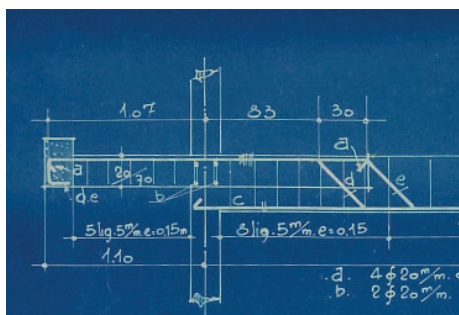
Plano del forjado de techo de planta baja de la Villa Cook a escalas 1:50, 1:20 y 1:10, Summer. FLC 08355 (pormenor)
